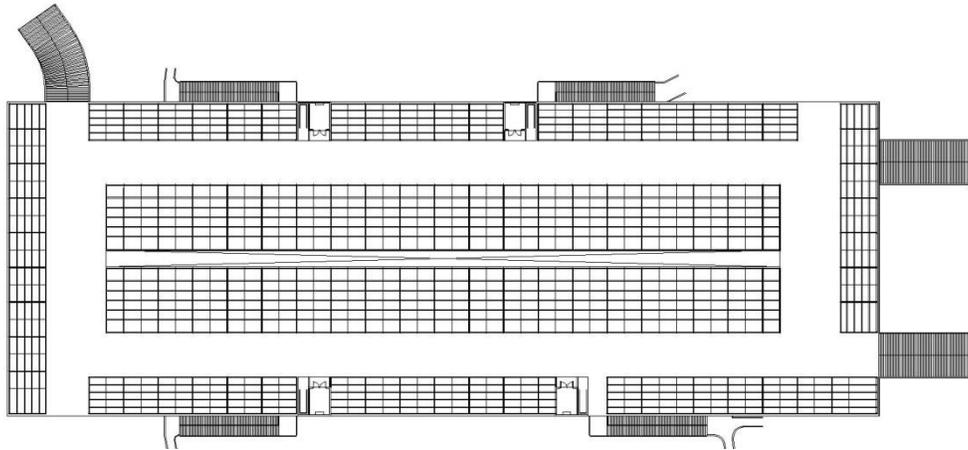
39. Planta Arquitectónica Estacionamiento Nivel 1
